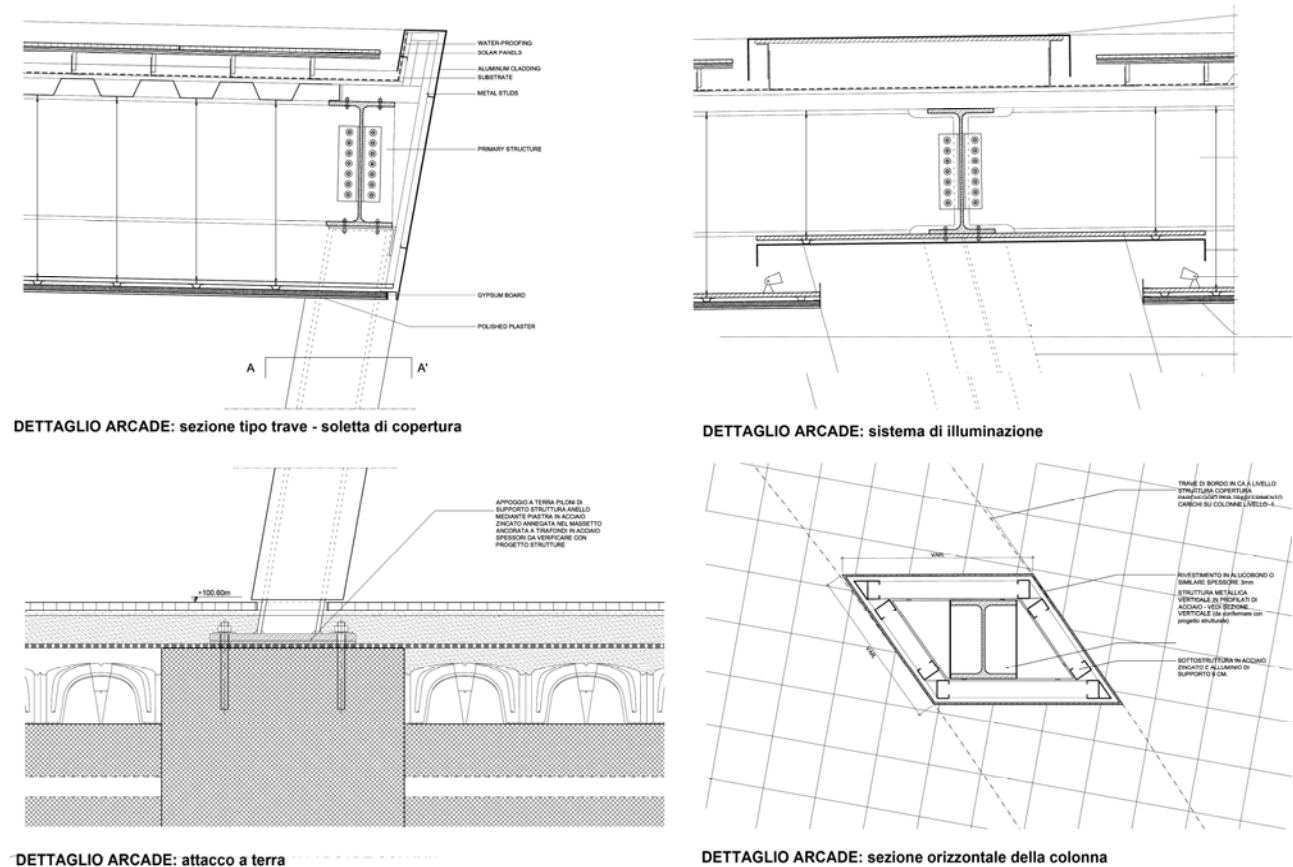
Dettagli tipo dell'Arcade (porticato) e Infopoint
